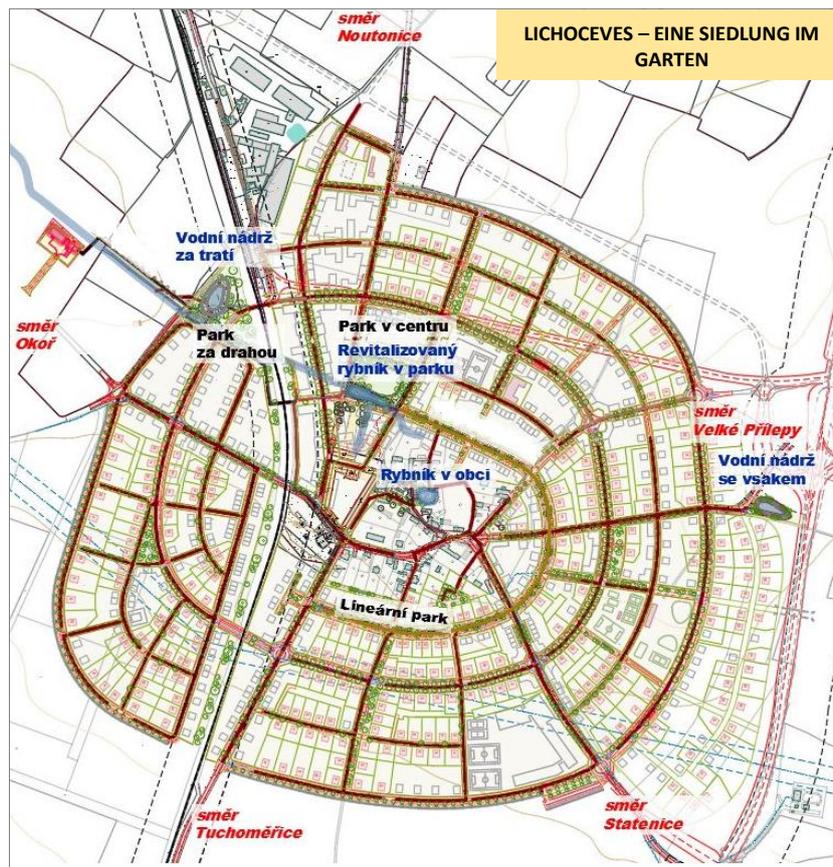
Lageplan Lichoceves – eine Siedlung im Garten; Bebauung auf 110 ha mit einem Regenwassermanagementkonzept
